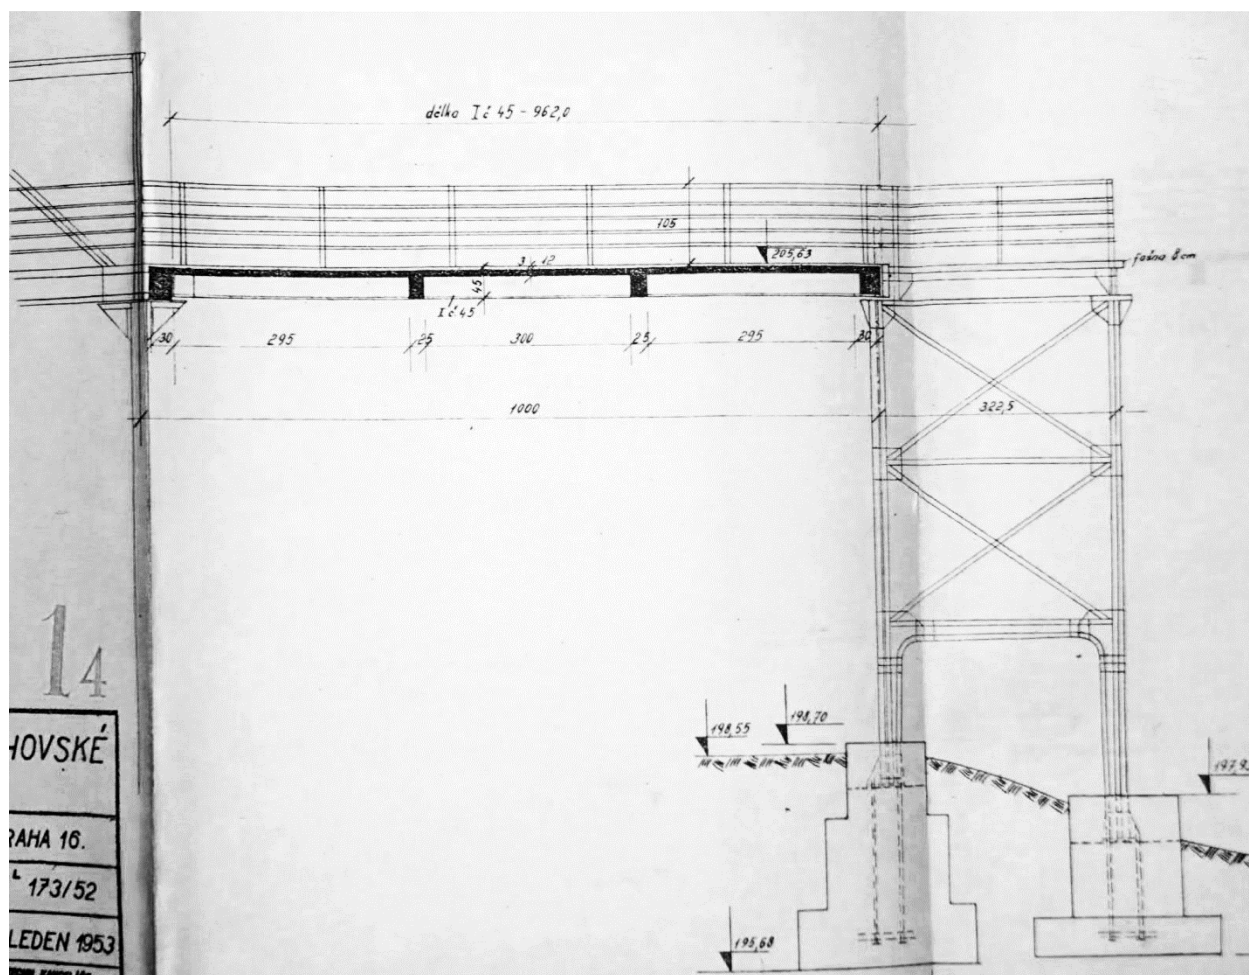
Typický příčný řez příhradovou konstrukcí lávky (zdroj: BMS)
